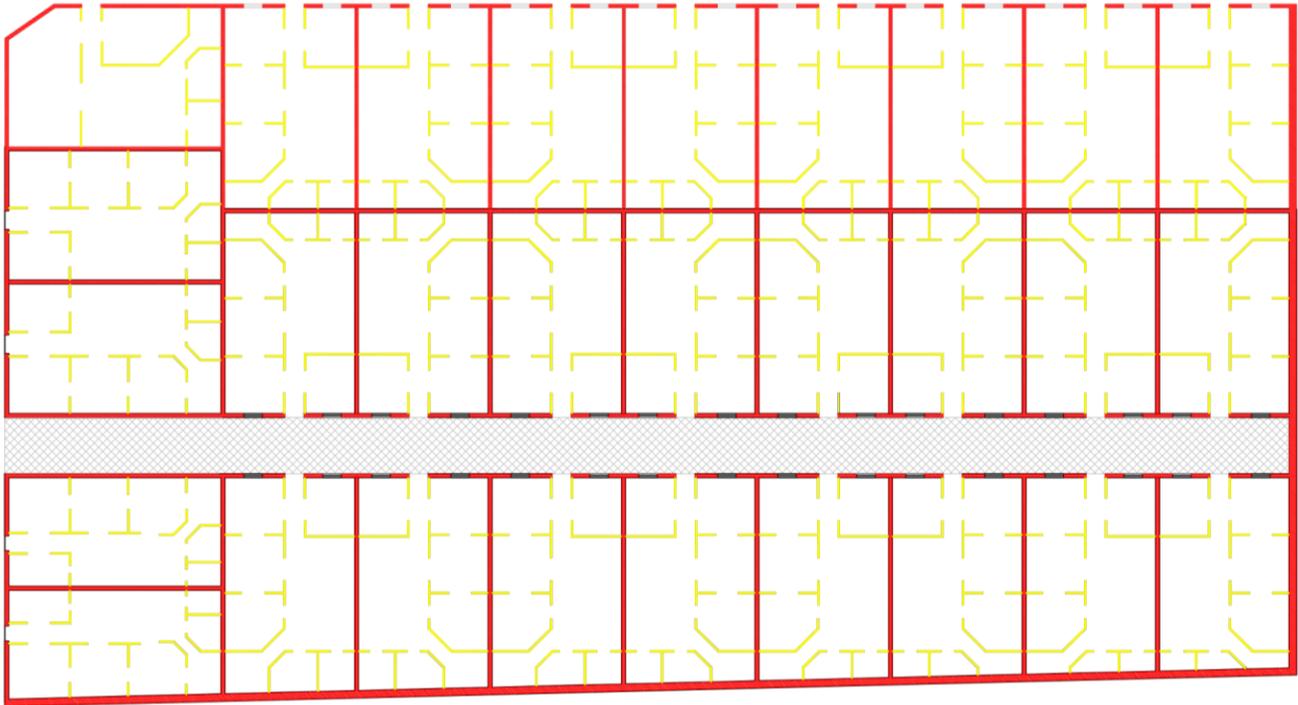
Planta Sistema Constructivo ROJO: Albañilería \_ AMARILLO: Tabiquería
